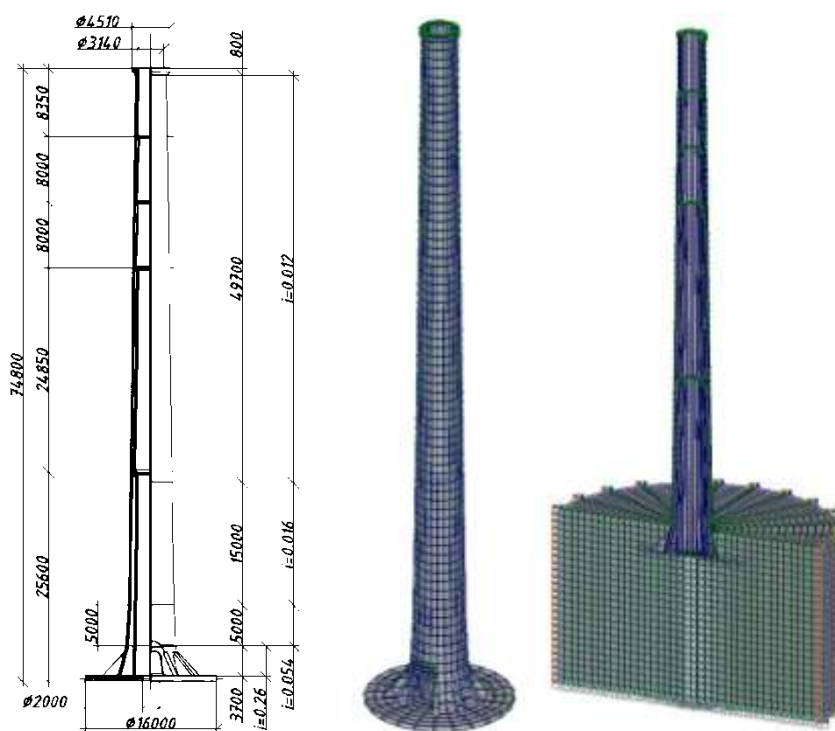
Конечноэлементная расчетная схема железобетонной дымовой трубы
